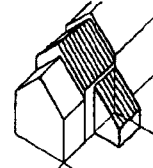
bâtiment secondaire en appentis au mur gouttereau
